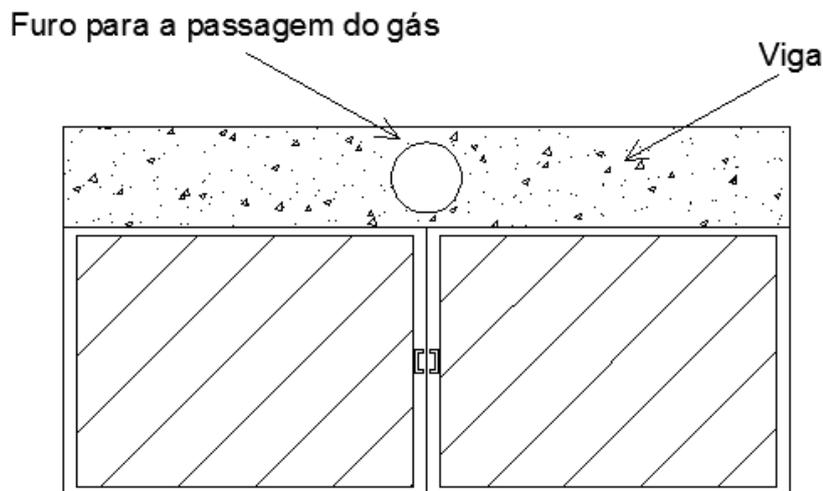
Esquema mostrando furação atravessando a viga (FONTE: O autor)
